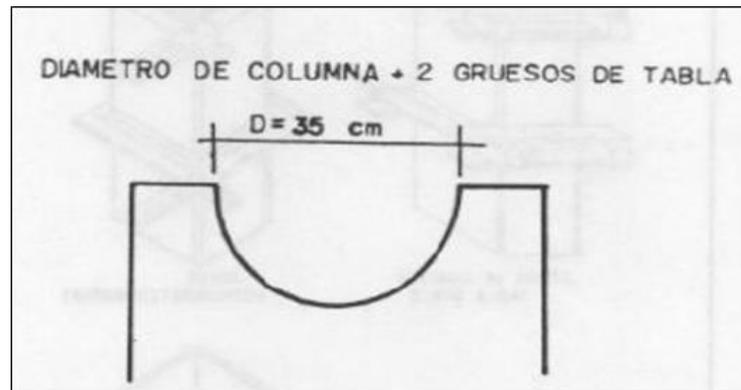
Diámetro de los camones para encofrado de columnas circulares.
